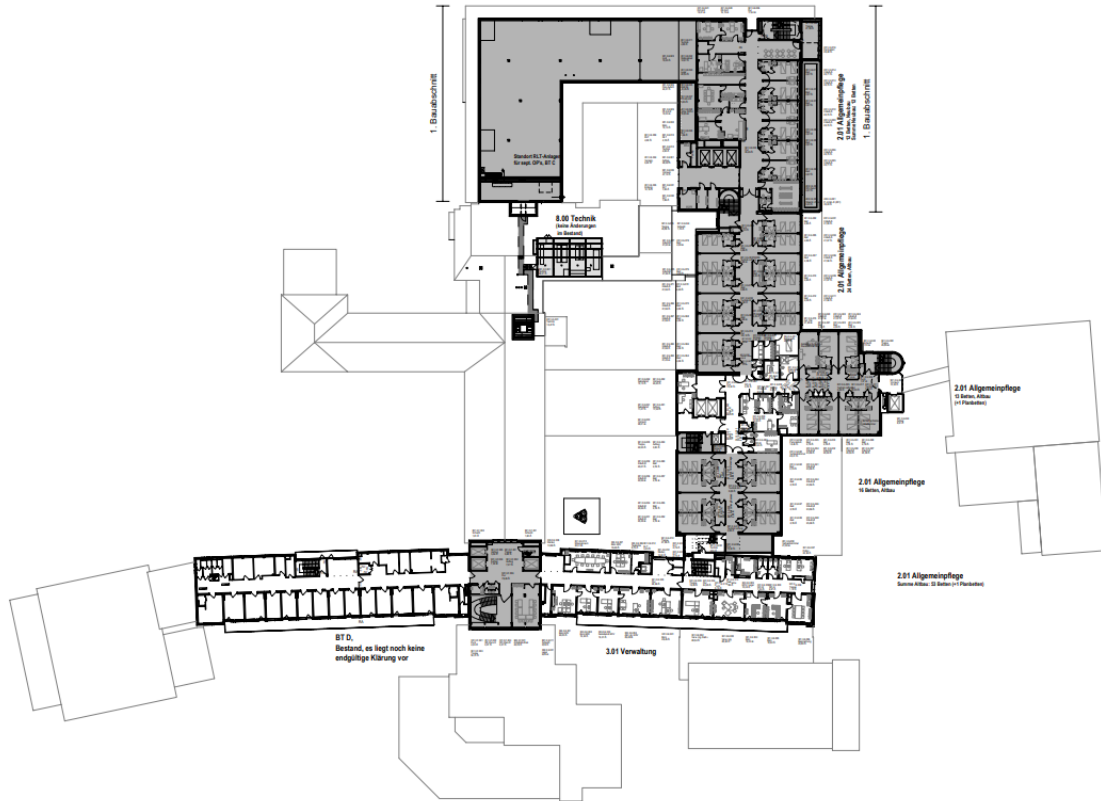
Grundriss 3. Obergeschoss mit Brandschutzmängeln (grau)
